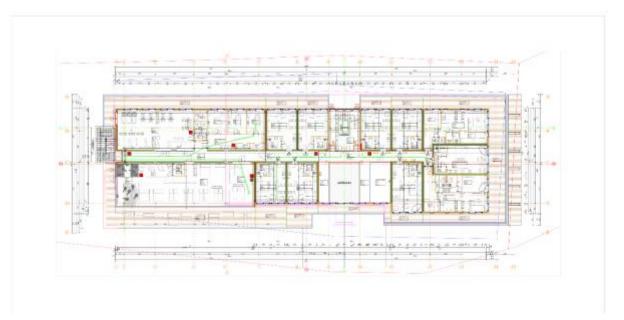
Grundriss 1. Obergeschoss (nicht maßstäblich)
